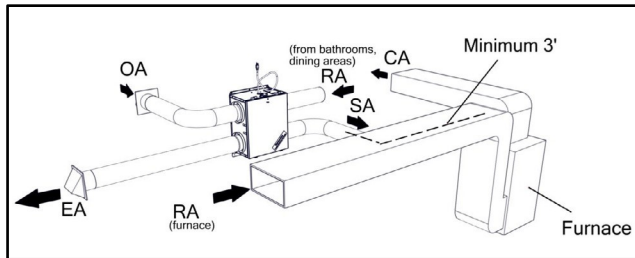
PRISE D'AIR DE RETOUR SÉPARÉE — ALIMENTATION EN AIR DE LA CHAUDIÈRE CONDUITE D'AIR DE RETOUR
